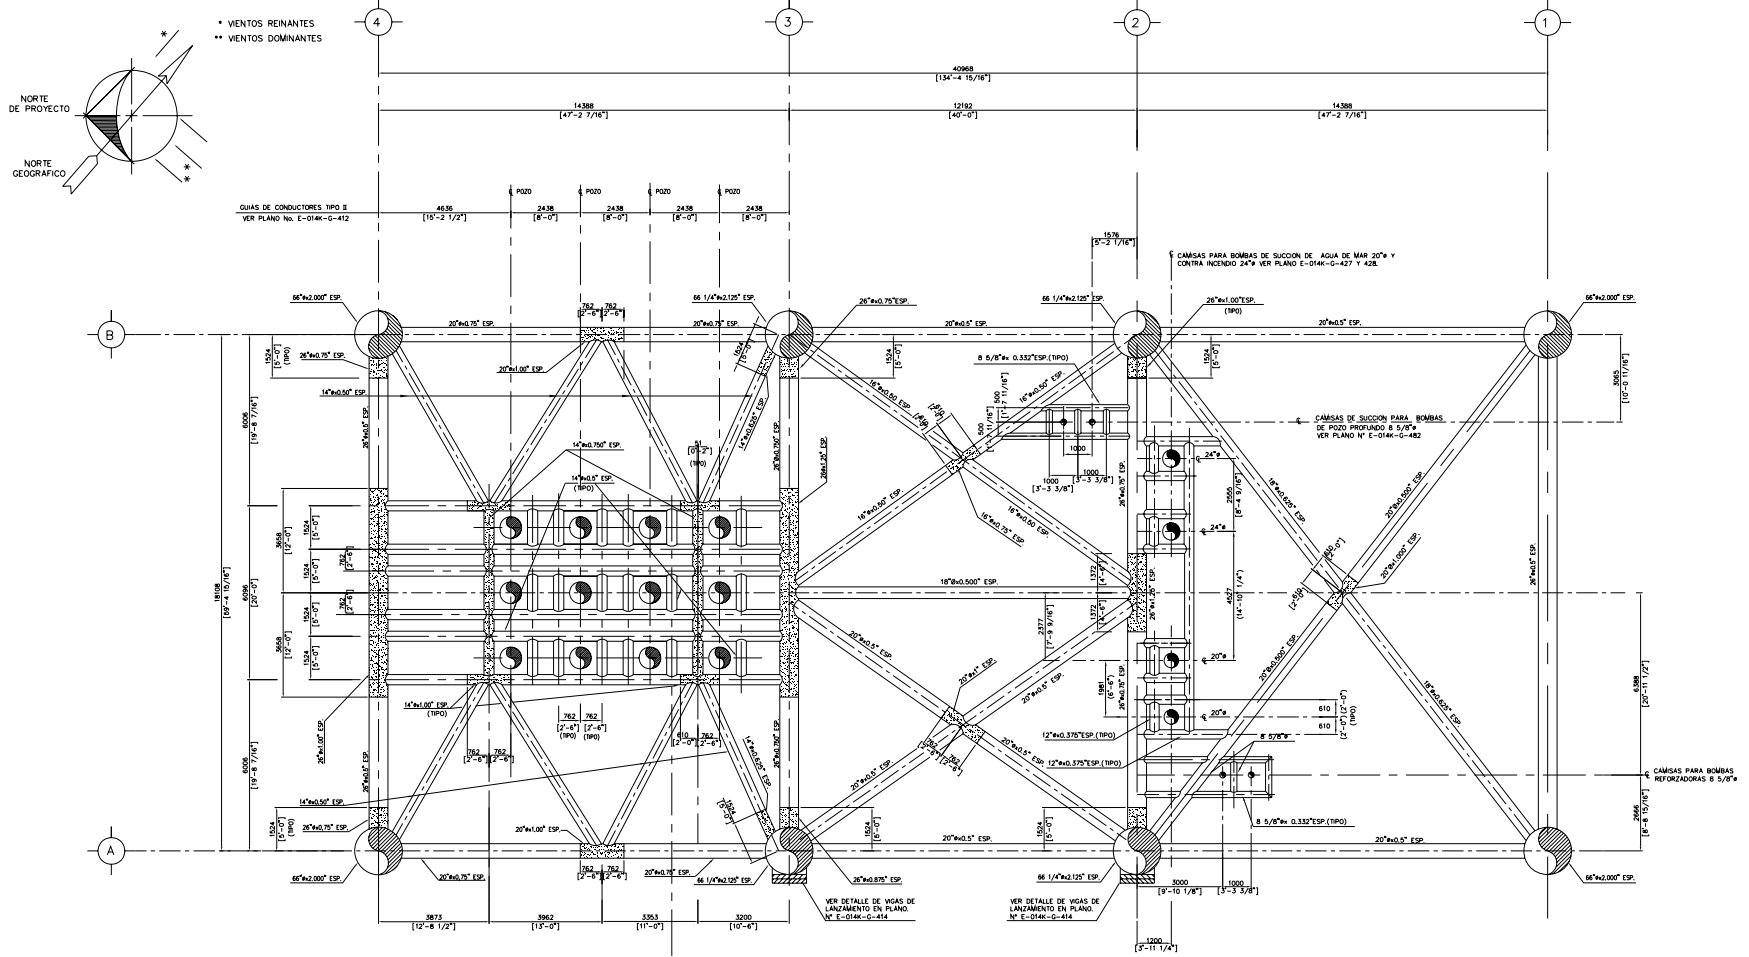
Planta en elevación (-) 7.000 m (22'-11 9/16").
